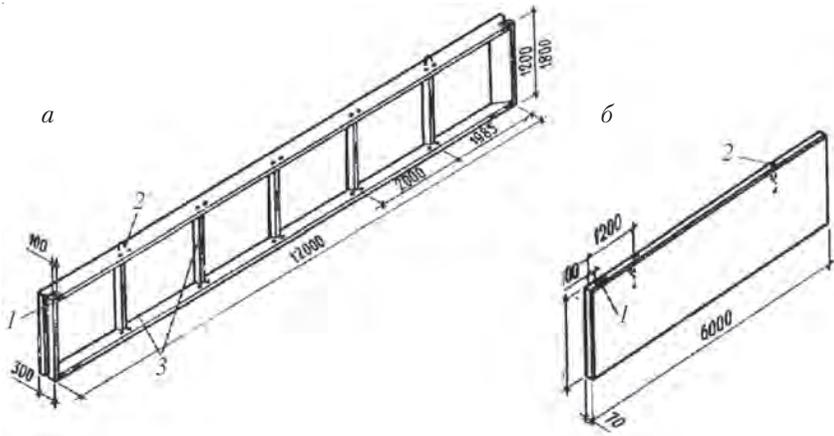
Железобетонные панели неотапливаемых зданий:
